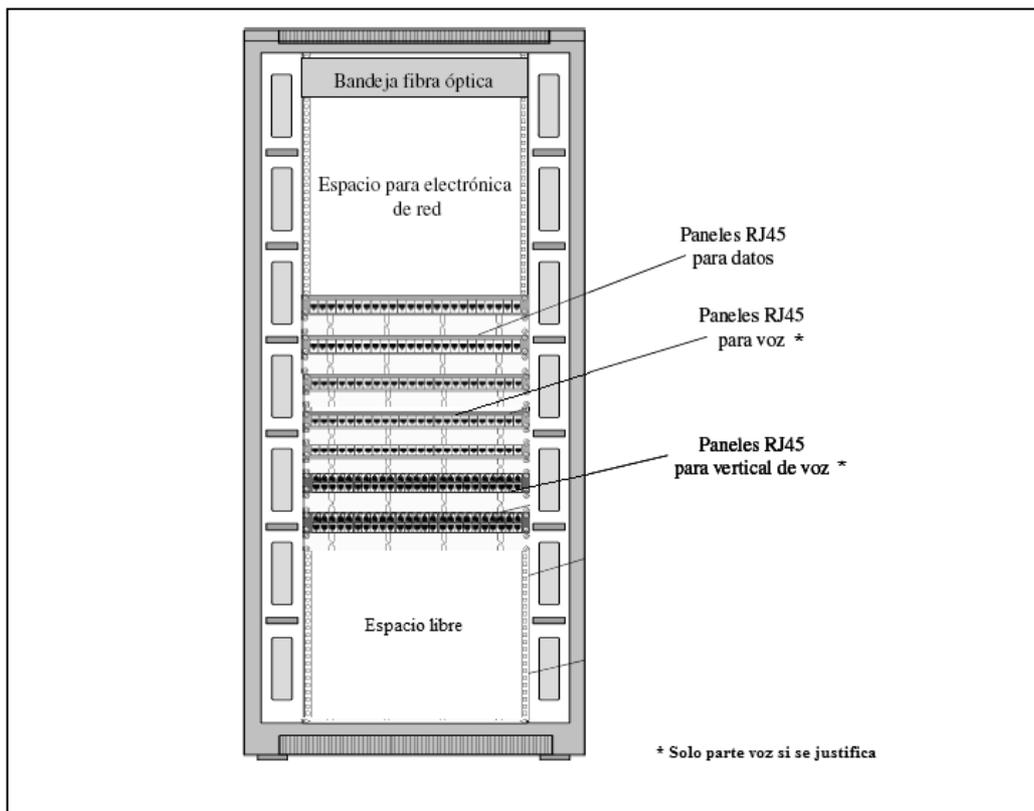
Estructura del rack ubicado en el Repartidor de Planta (RP)
